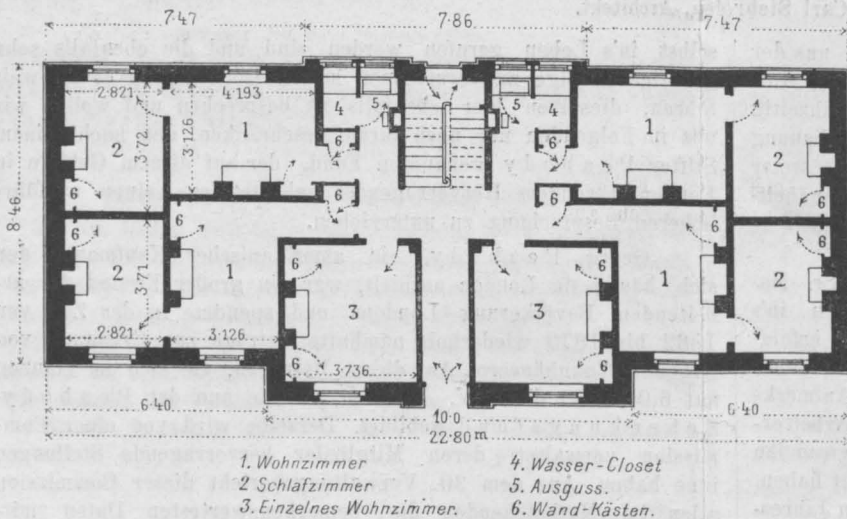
Ebenerd-Grundriss eines Peabody-Hauses.
